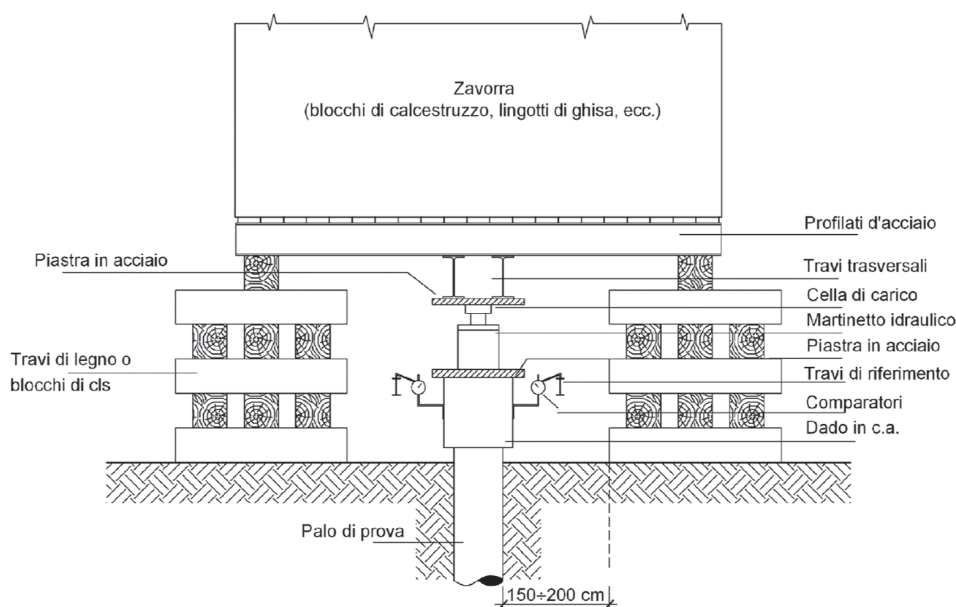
Schema di applicazione del carico di prova su palo di fondazione con cassone zavorrato
